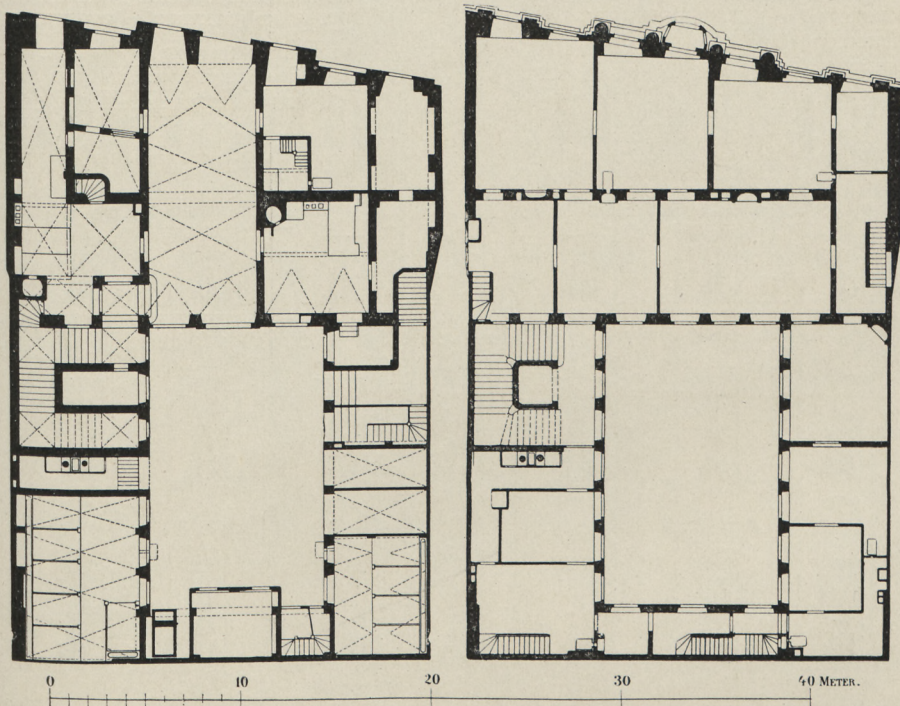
und 395. Hôtel de Saxe, Grundriss des Erd- und Hauptgeschosses. Zustand nach 1764.
